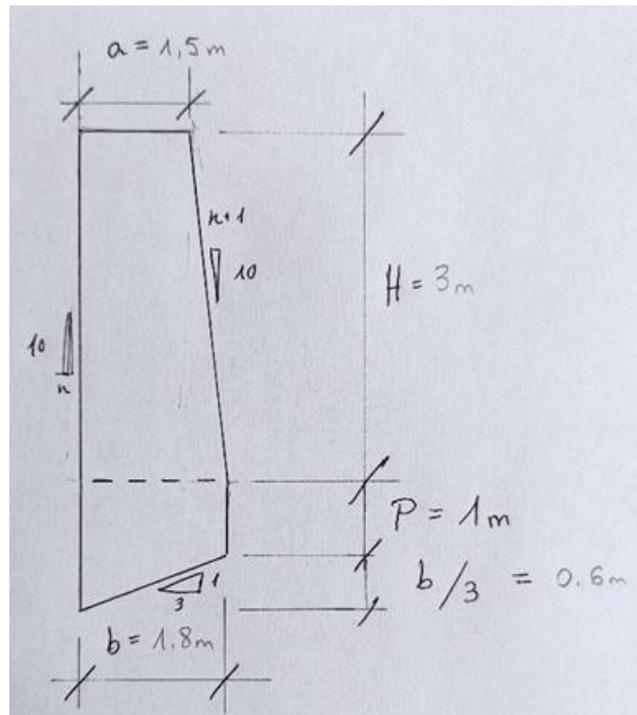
Sección del muro de escollera definido en el proyecto y que se empleará para sustituir el entramado metálico de estabilización del muro 4.
